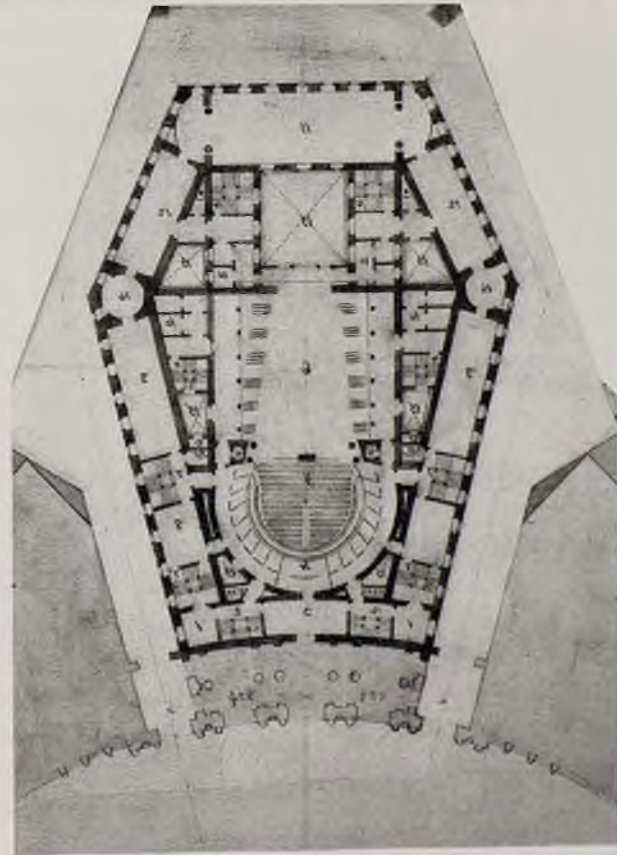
Planta del Teatro Real. (Archivo de Villa).
